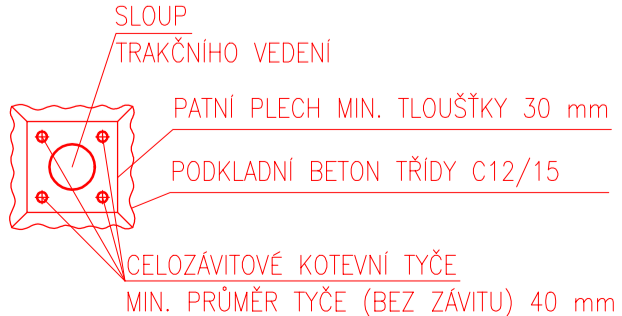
### DETAIL KOTVENÍ TRAKČNÍHO VEDENÍ - ŘEZ
